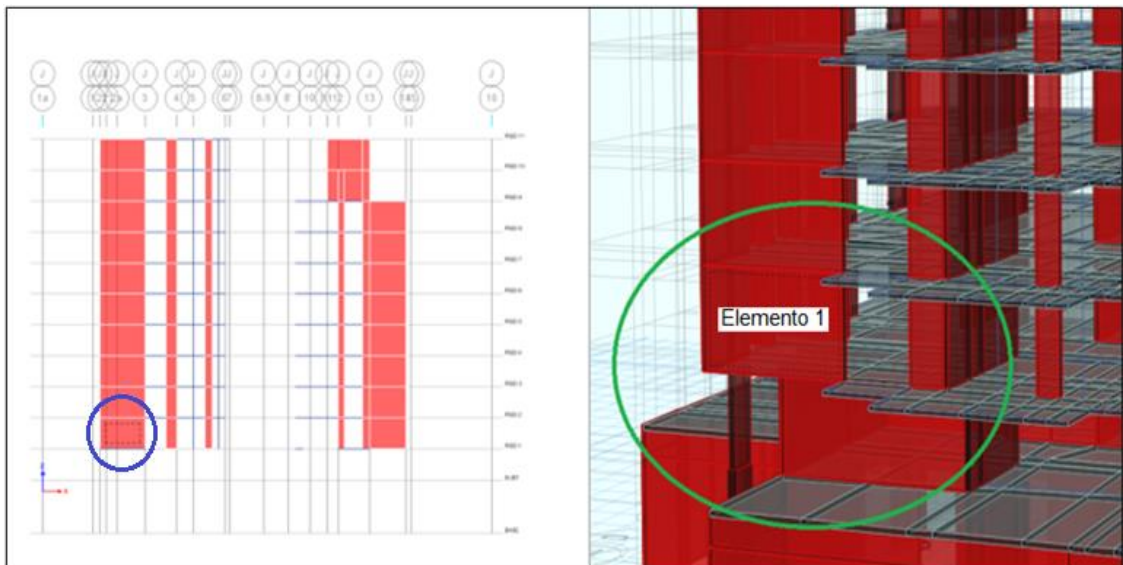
Elemento fuera del plano vertical, edificio T15 vista en elevación y en 3D (elemento 1)
